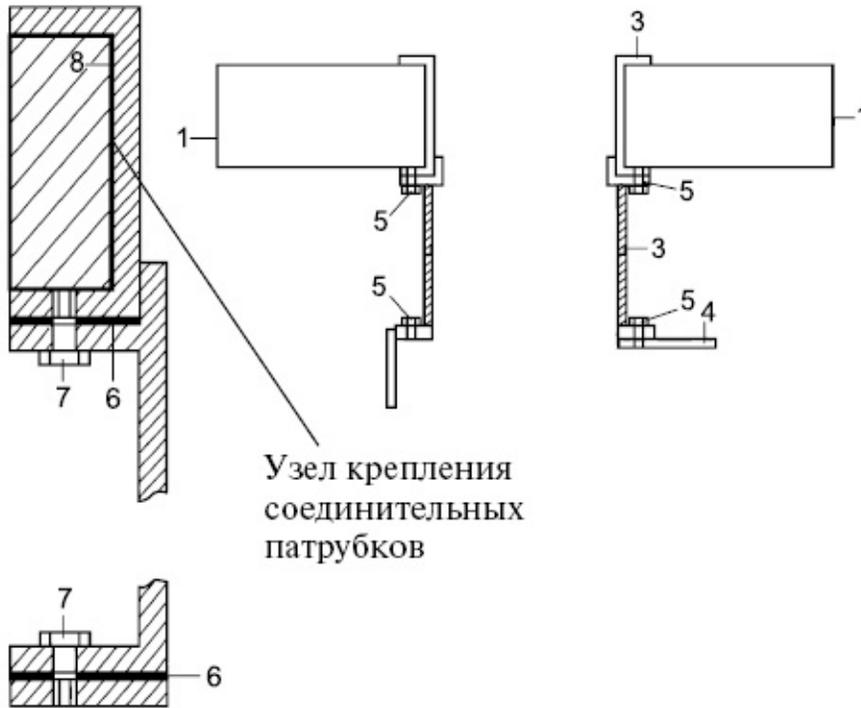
Узел соединения отопительного щитка и стального топливника: 1 – кирпич; 2 – соединительный патрубок; 3 – переходной патрубок между топливником и отопительным щитком и место соединения к стальному топливнику; 5 – крепеж соединительного и переходного патрубков; 6 – прокладка асбестовая; 7 – болты крепления; 8 – уплотнитель между кирпичом
